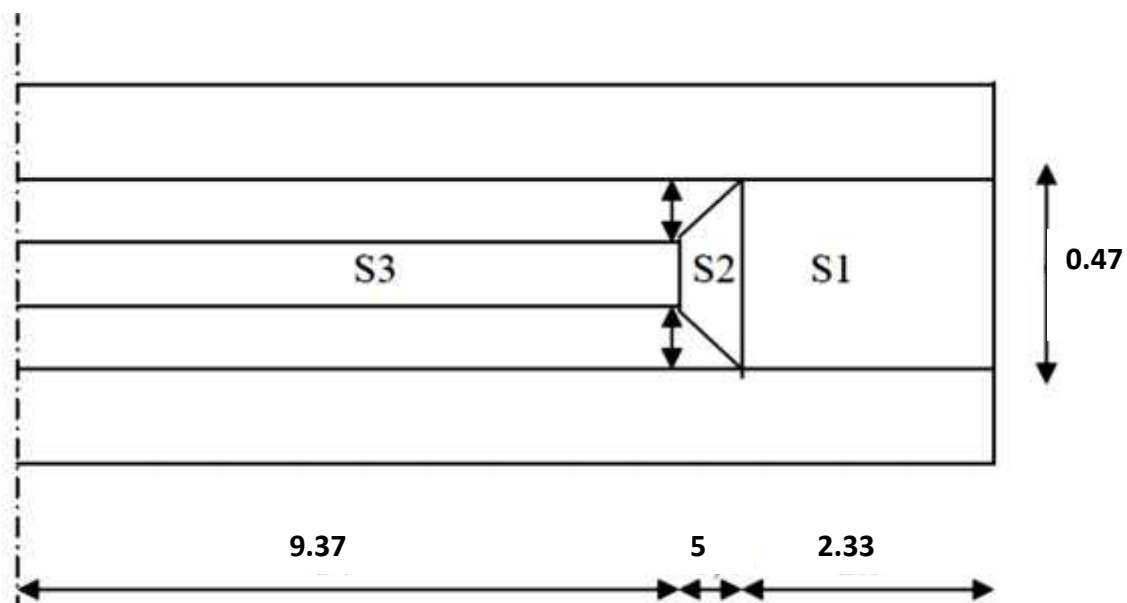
Coupe longitudinale de l'âme de la poutre
